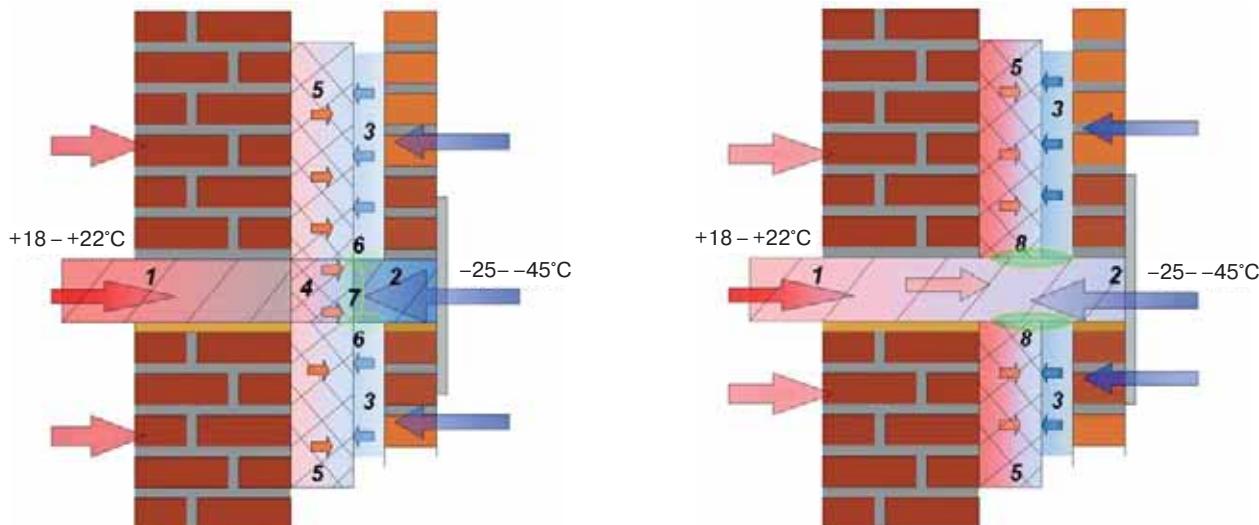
Сечение стены и перекрытия с теплоизолирующей вставкой (а) и без вставки (б): 1, 2 – плита перекрытия; 3 – воздушный зазор; 4 – теплоизолирующая вставка (МВП); 5 – утеплитель стены; 6, 7, 8 – зона контакта бетона и утеплителя
